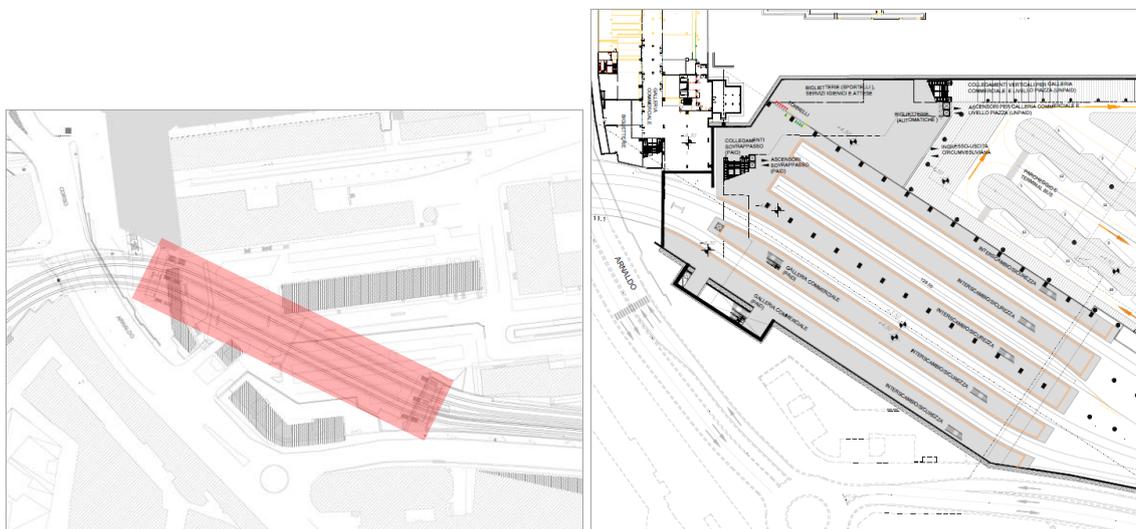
Pianta stazione EAV Piazza Garibaldi (ante e post operam)
